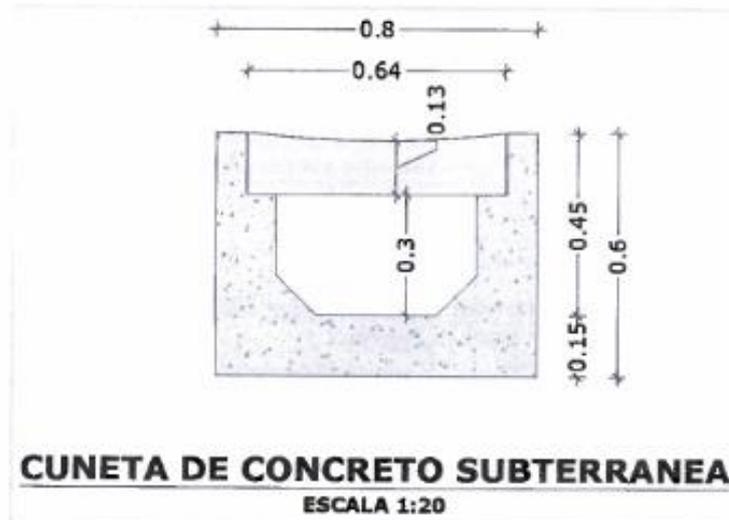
SECCION TRANSVERSAL DE CUNETA SUBTERRANERA DE CONCRETO.
